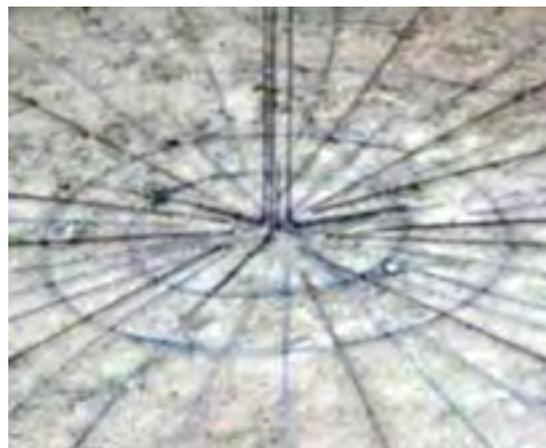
Imagem dos ferros da base do pilar central e do mesmo sendo preenchido com concreto.
